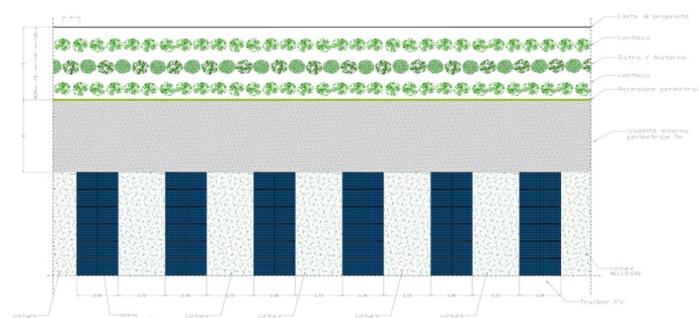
Vista in pianta dell'area dell'impianto con indicazione delle colture
